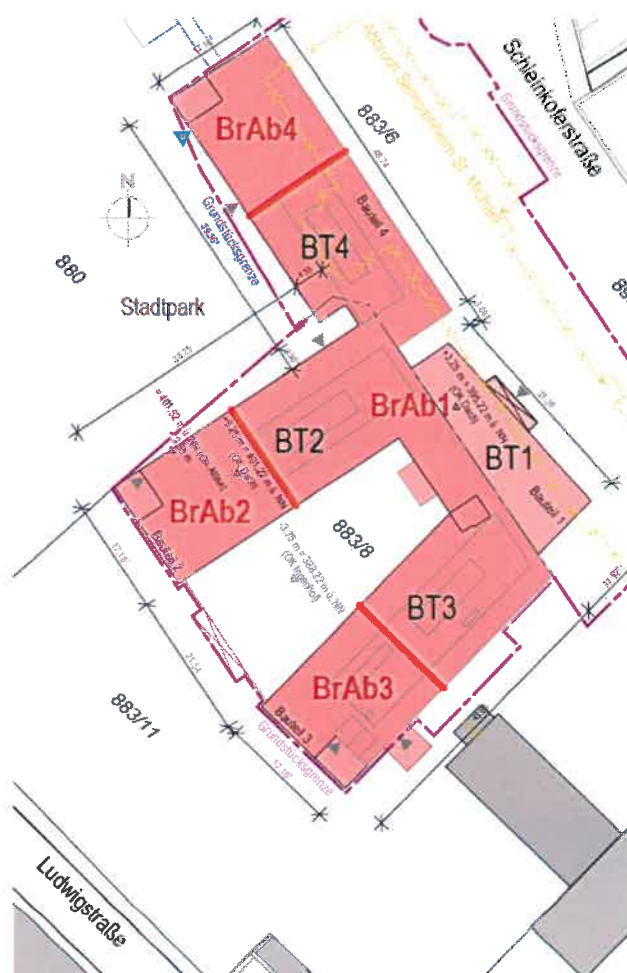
Lageplan (Übersicht Bauteile [BT], Brandabschnitte [BrAb])
